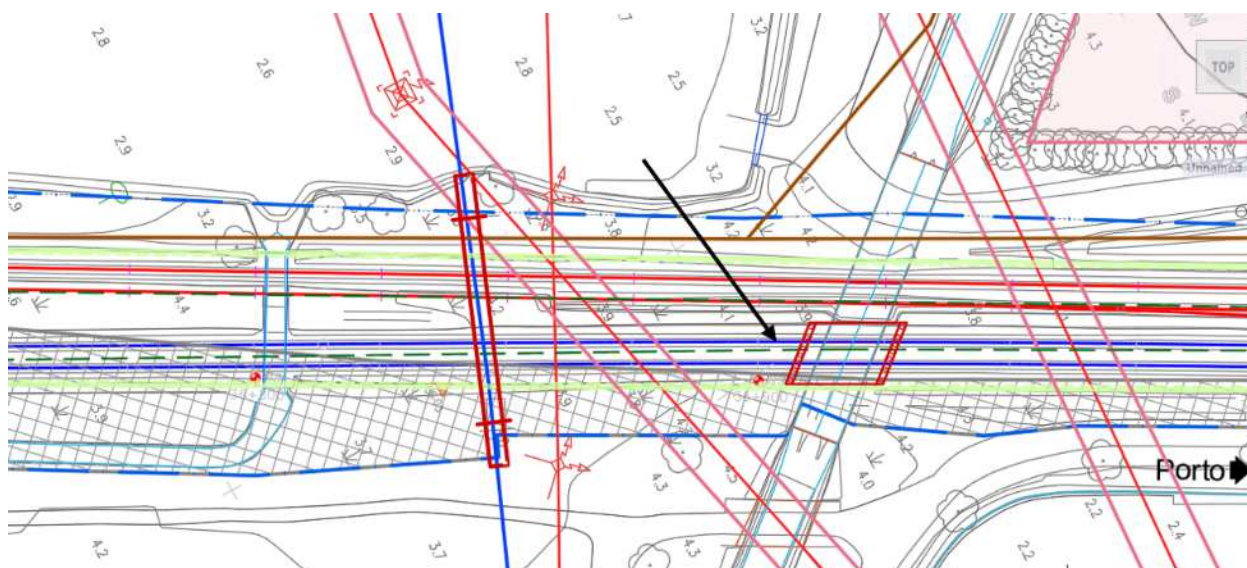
PK 36+917 – Atravessamento de condutas do canal de restituição (Telas Finais de 2004 des. LN1293623)
